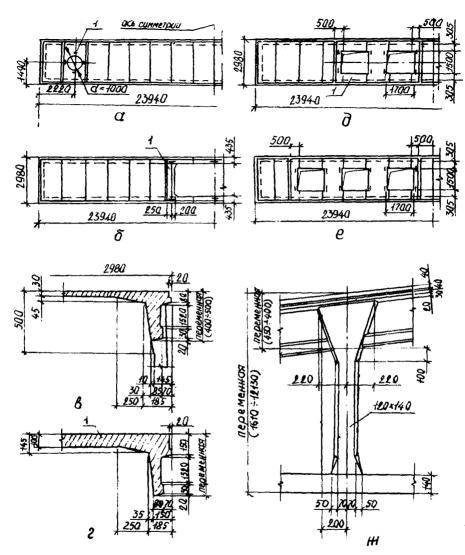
Складчатые панели-оболочки КСО 3х24м а-с пролегом для воздуховода или коншного вентилятора; б.д-с проемами для зенитных и светоаэрационного фонарей; в-поперечное сечение верхнего пояса арочной диафрагмы; г-то же, с утопшению полкой у проемов; е-с проемами для легкосорасываемой кровли: ж-конструкция стоек фермы-диафрагмы; г-утопшения полки у проемов
